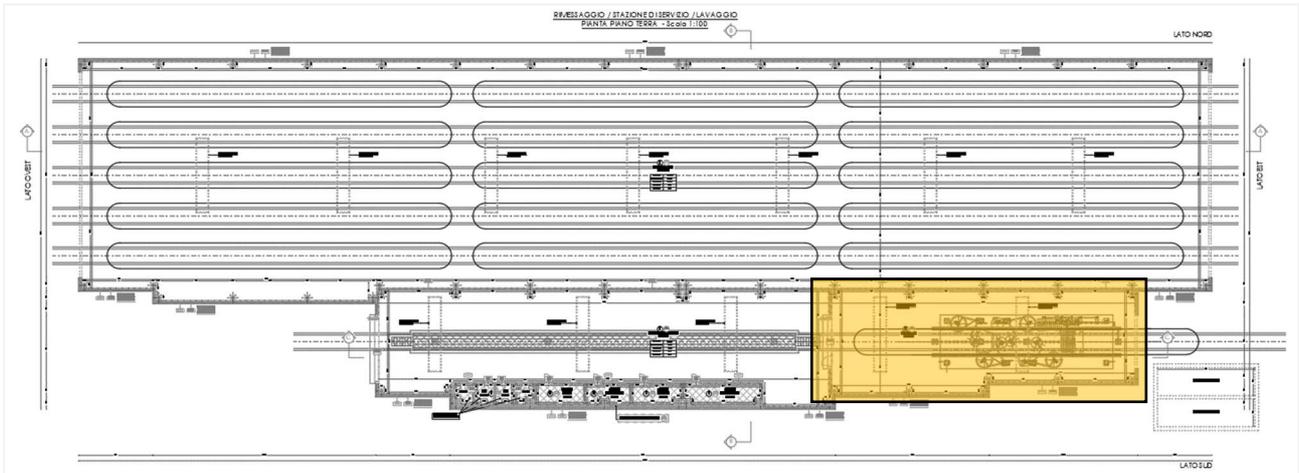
Vista planimetrica rimessa - impianto di lavaggio in evidenza
